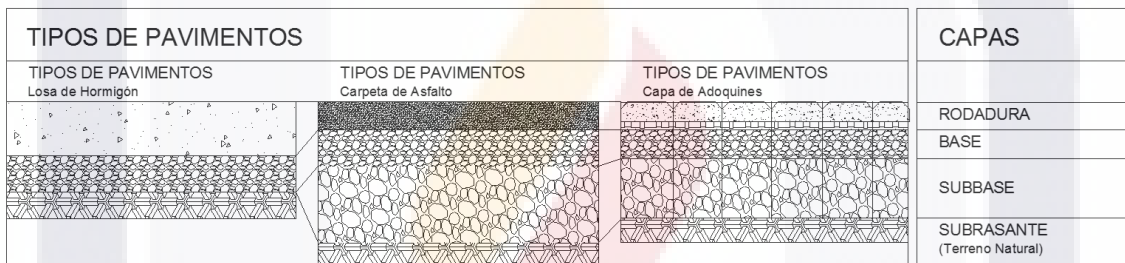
Tipos de pavimentos. Elaboración propia, fuente: ICH, 2013, p.3.
